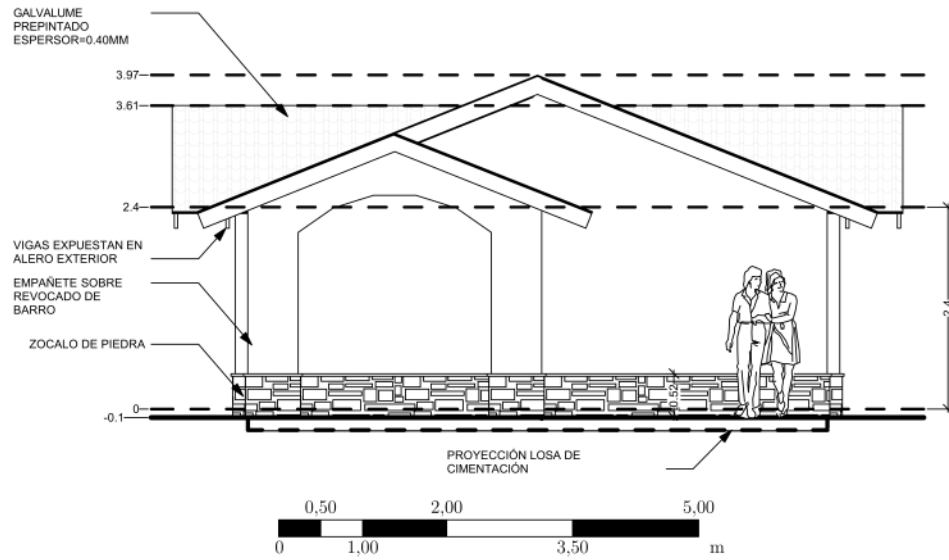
Elevación posterior (Sur-Este) del proyecto para Sr. Gerardo Campoverde.
